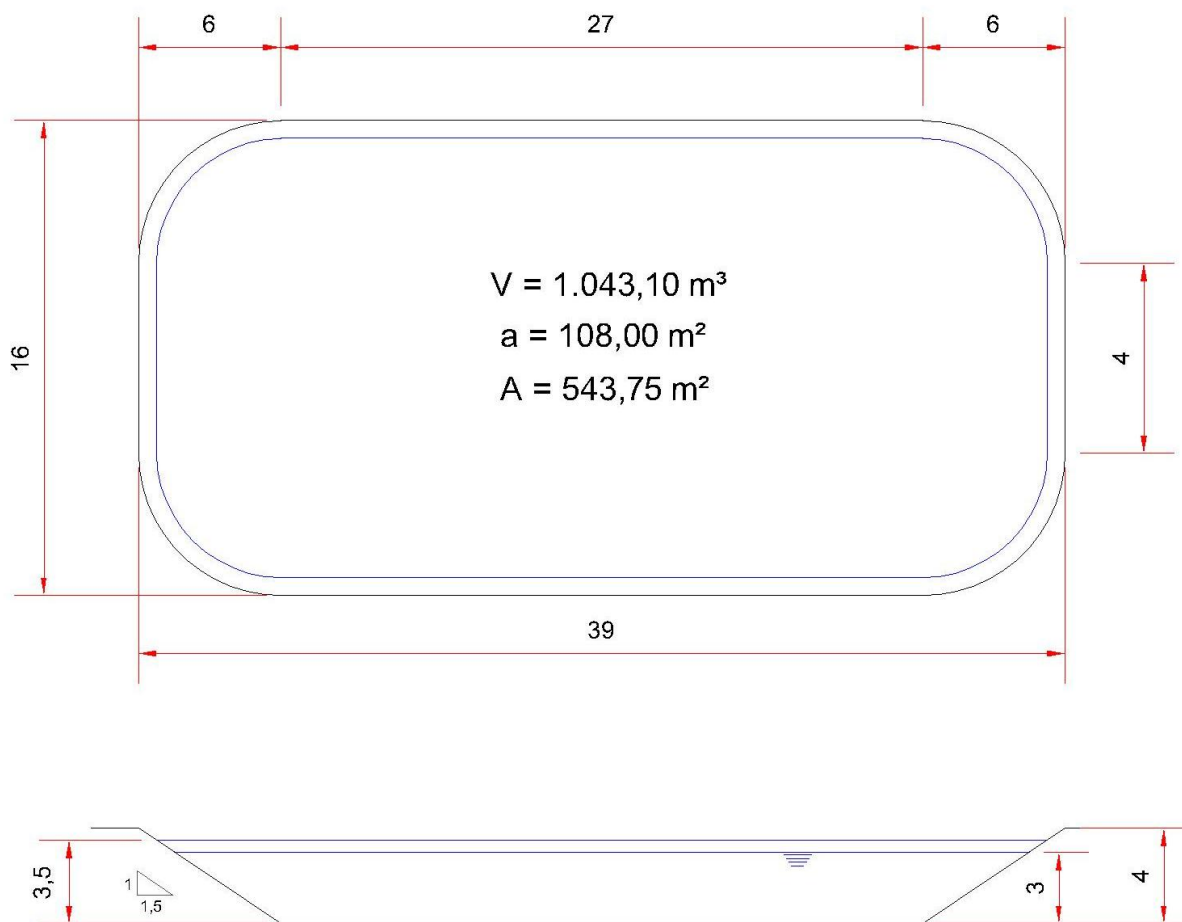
Croqui dimensões totais lagoa anaeróbia
